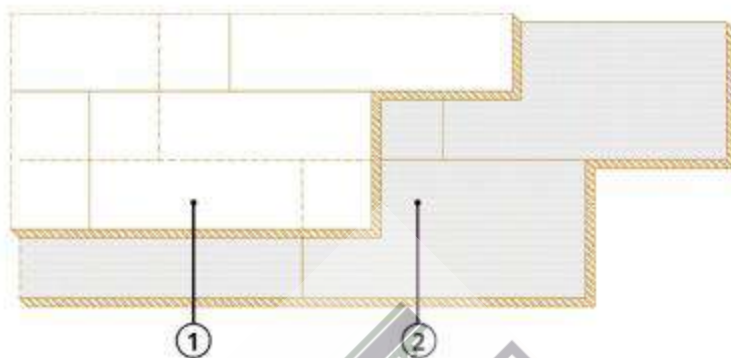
Смещение плит верхнего и нижнего слоев при укладке:
